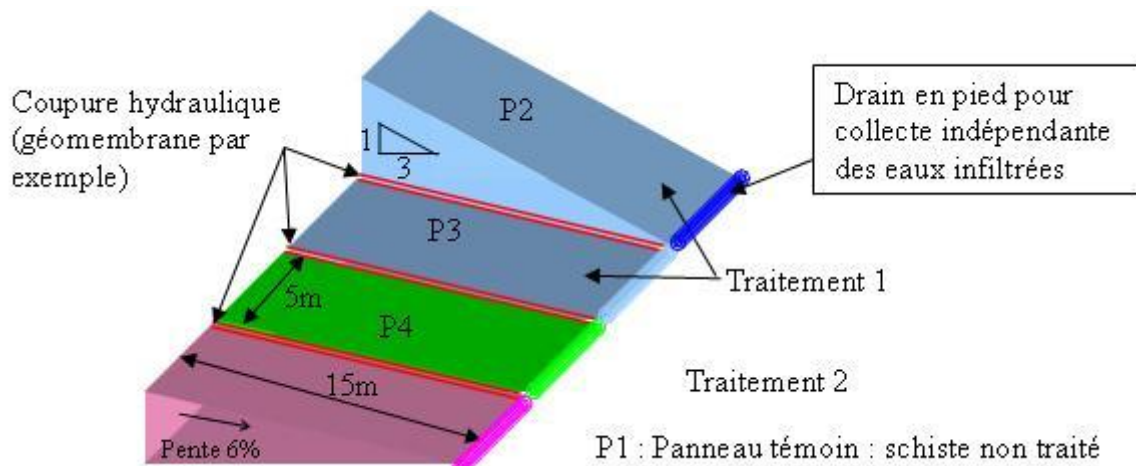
Schéma de principe de réalisation des planches d'essai
